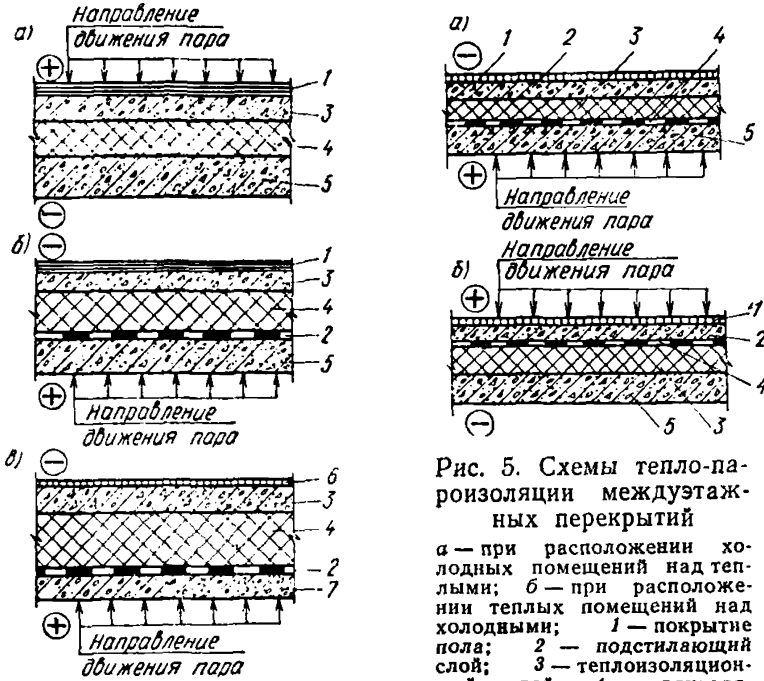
Схемы тепло-пароизоляции междуэтажных перекрытий
